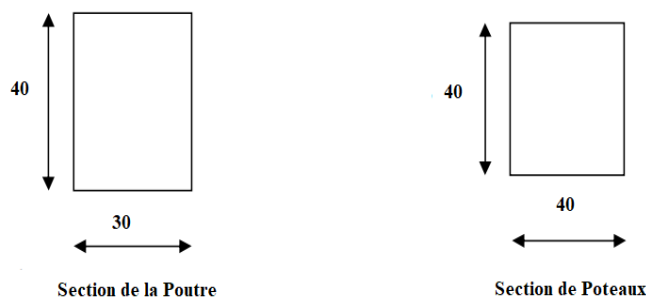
Dimensions des sections de béton des poutres et des poteaux des structures.
